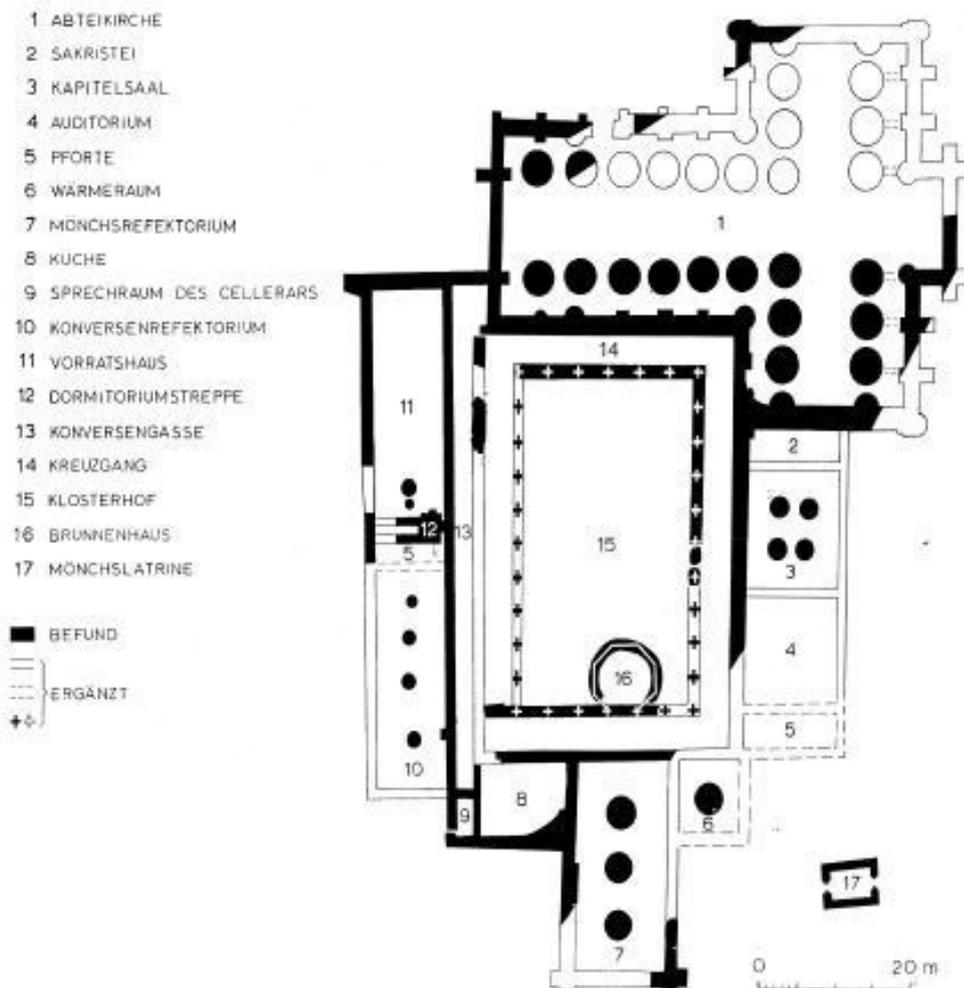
Rekonstruierter Grundriss von Kirche und Klausur in Klaarkamp.
